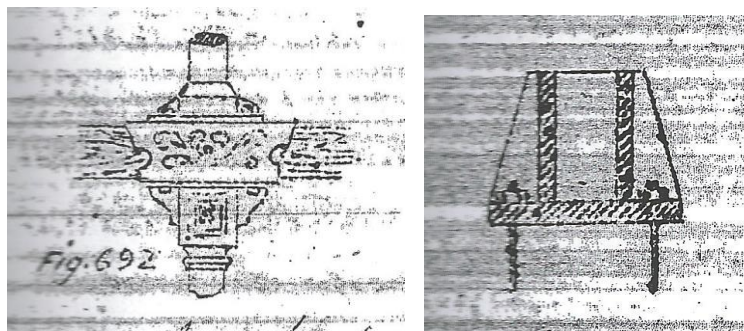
Capiteles de columna de fundición para sostenimiento de vigas de madera (88a) y perfiles de acero (88b). Fuente: (Anónimo, 1909).
